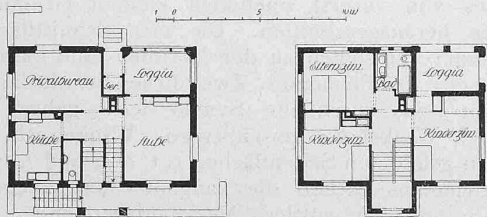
und 5. Grundrisse vom Erdgeschoss und Obergeschoss 1 : 400 des Einfamilienhauses Luisoni in Schlieren. Architekt J. B. Frisch in Zürich.
